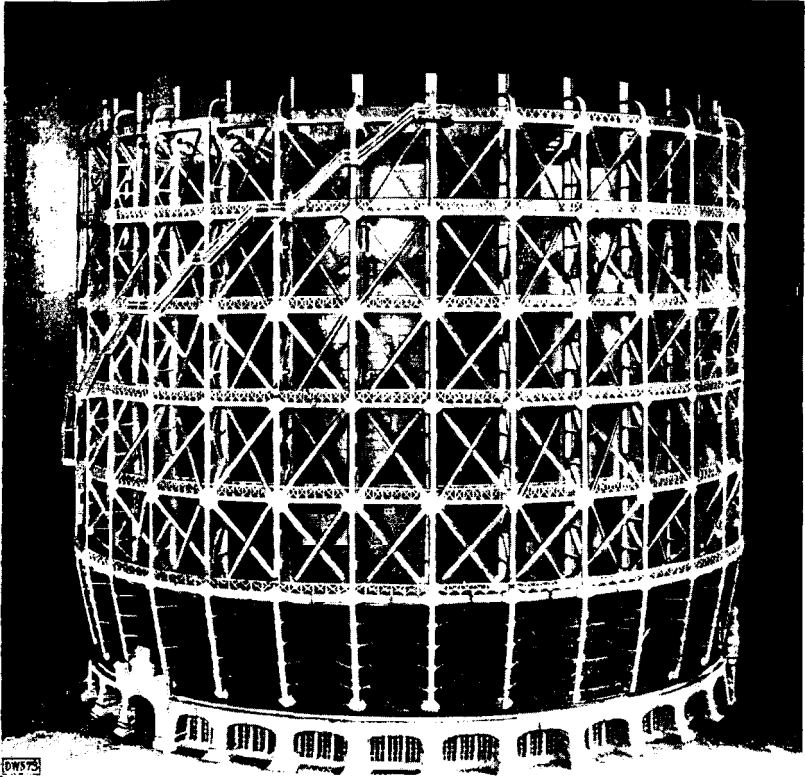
Ausziehbarer Glockengasbehälter im Gaswerk Hamburg
